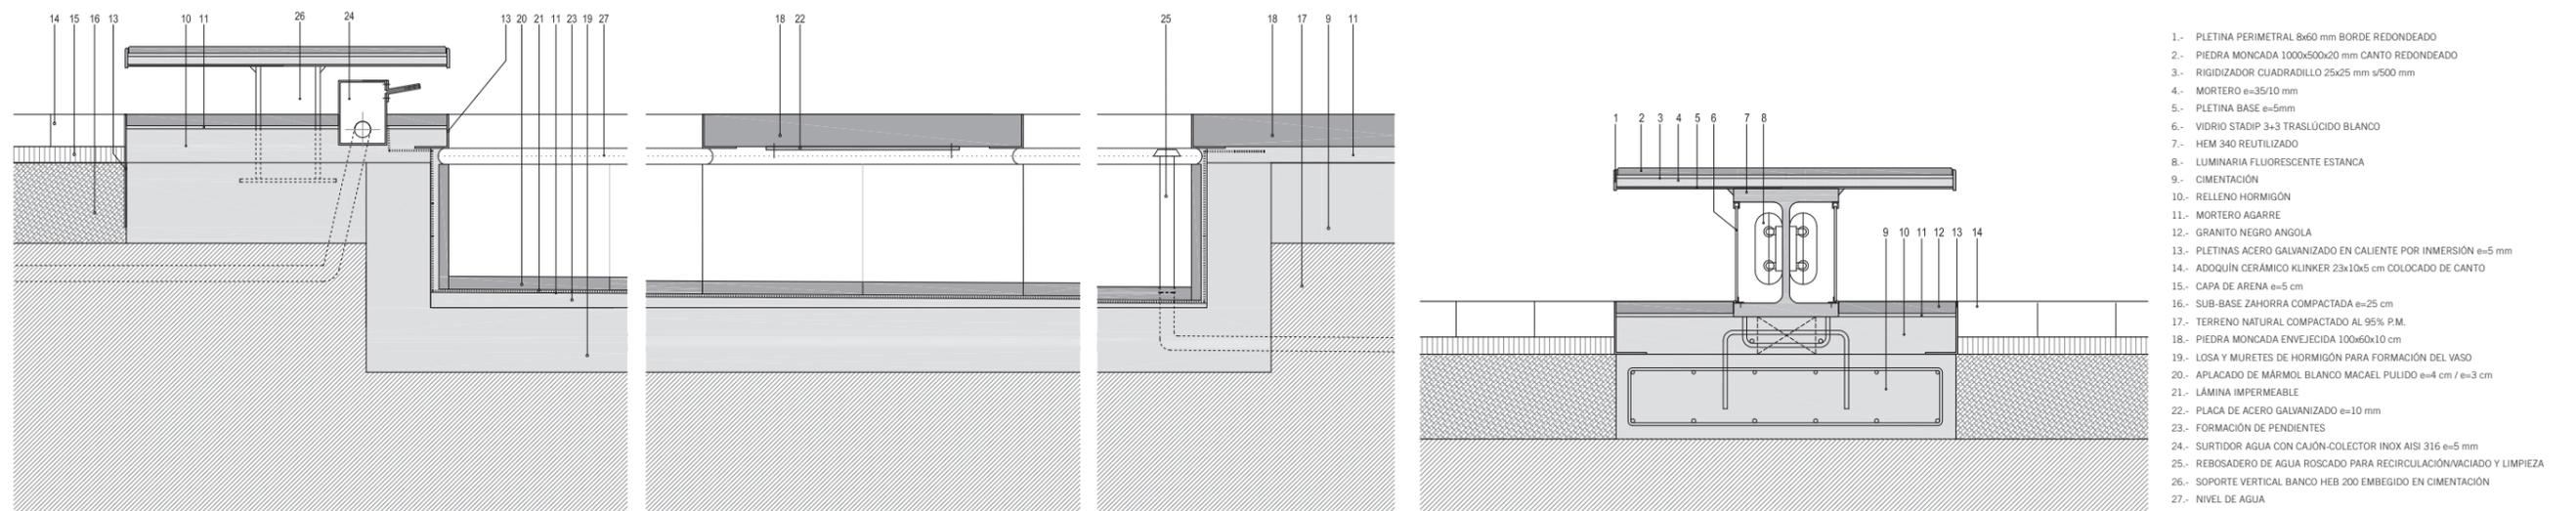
Detalles constructivos del patio Oeste. El superior seccionando la galería perimetral, el inferior seccionando el estanque de agua y el banco.
